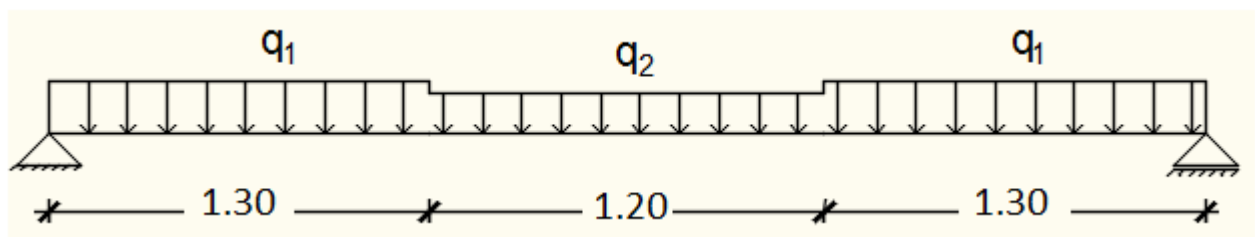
Schéma statique de la poutre brisée.
